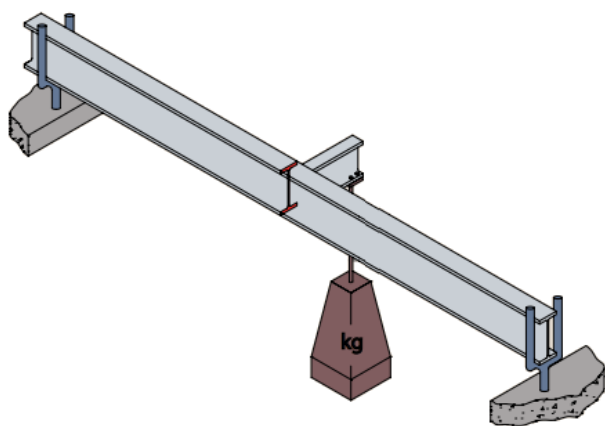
Exemplo de carregamento excêntrico em viga metálica (adaptado de Hughes et al., 2011).
